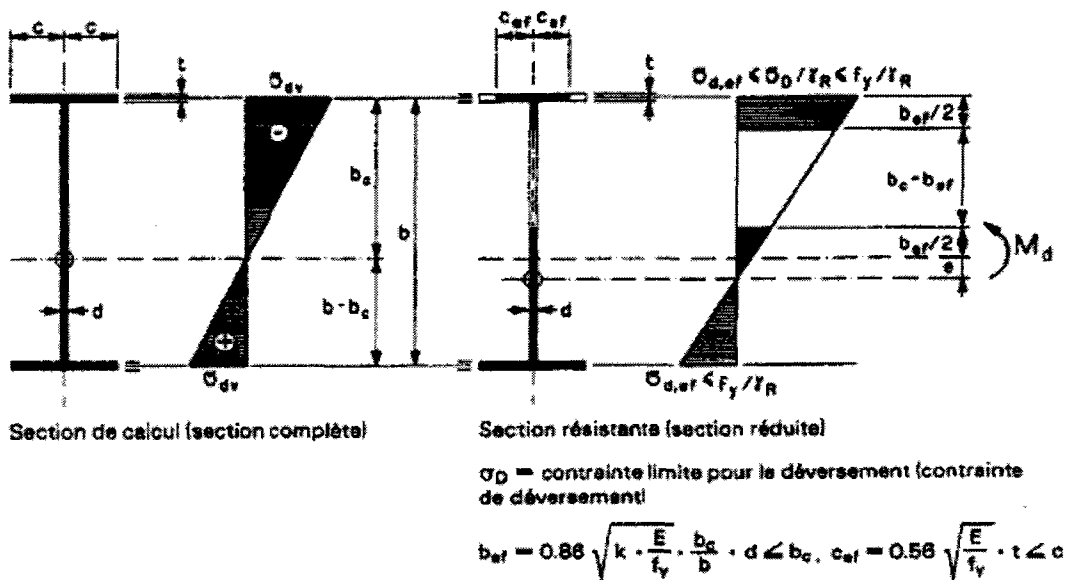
Section de calcul et section résistante d'une poutre composée à âme pleine
